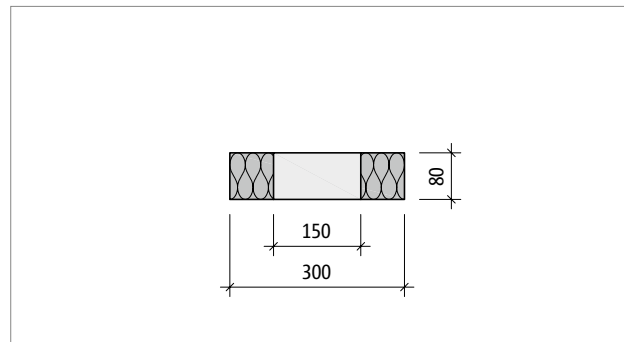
Schöck Sconnex® Typ W-N: Produktschnitt
